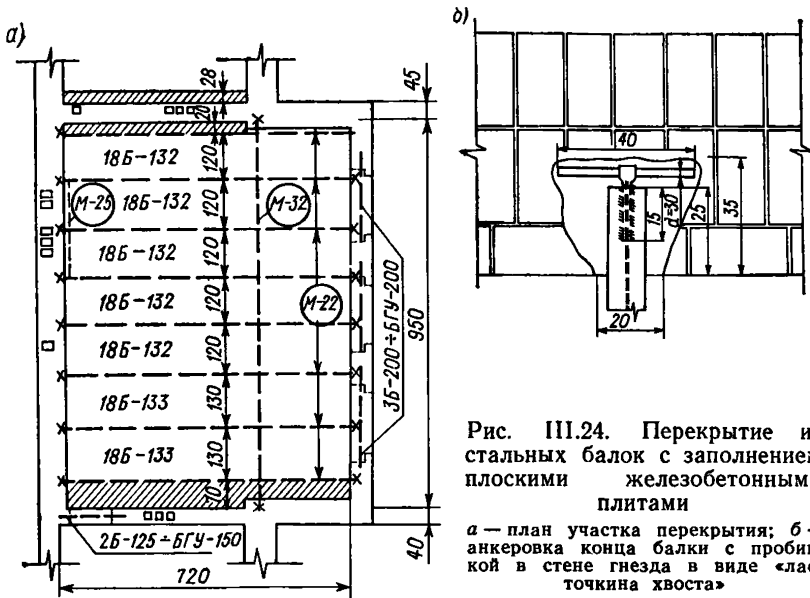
Перекрытие из стальных балок с заполнением плоскими железобетонными плитами
